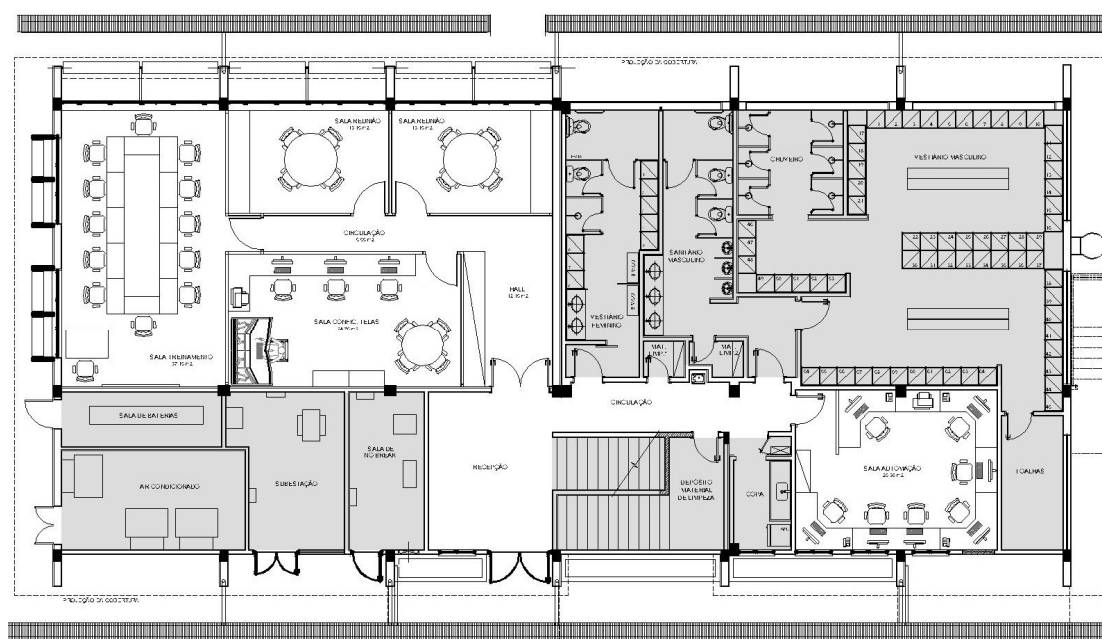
Planta baixa com a opção de *layout* final do pavimento térreo
